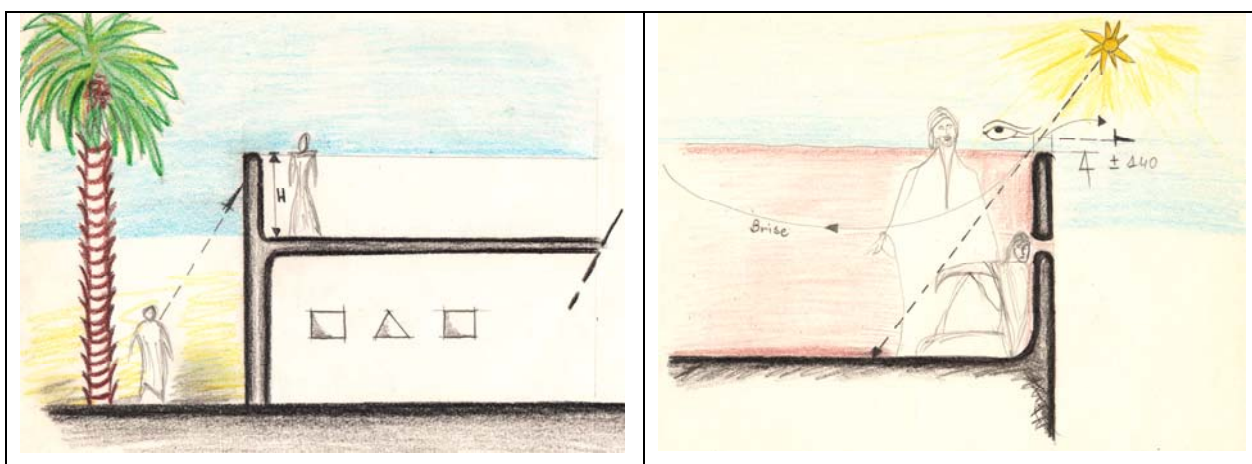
L'acrotère (Ravéreau A., 1981)
